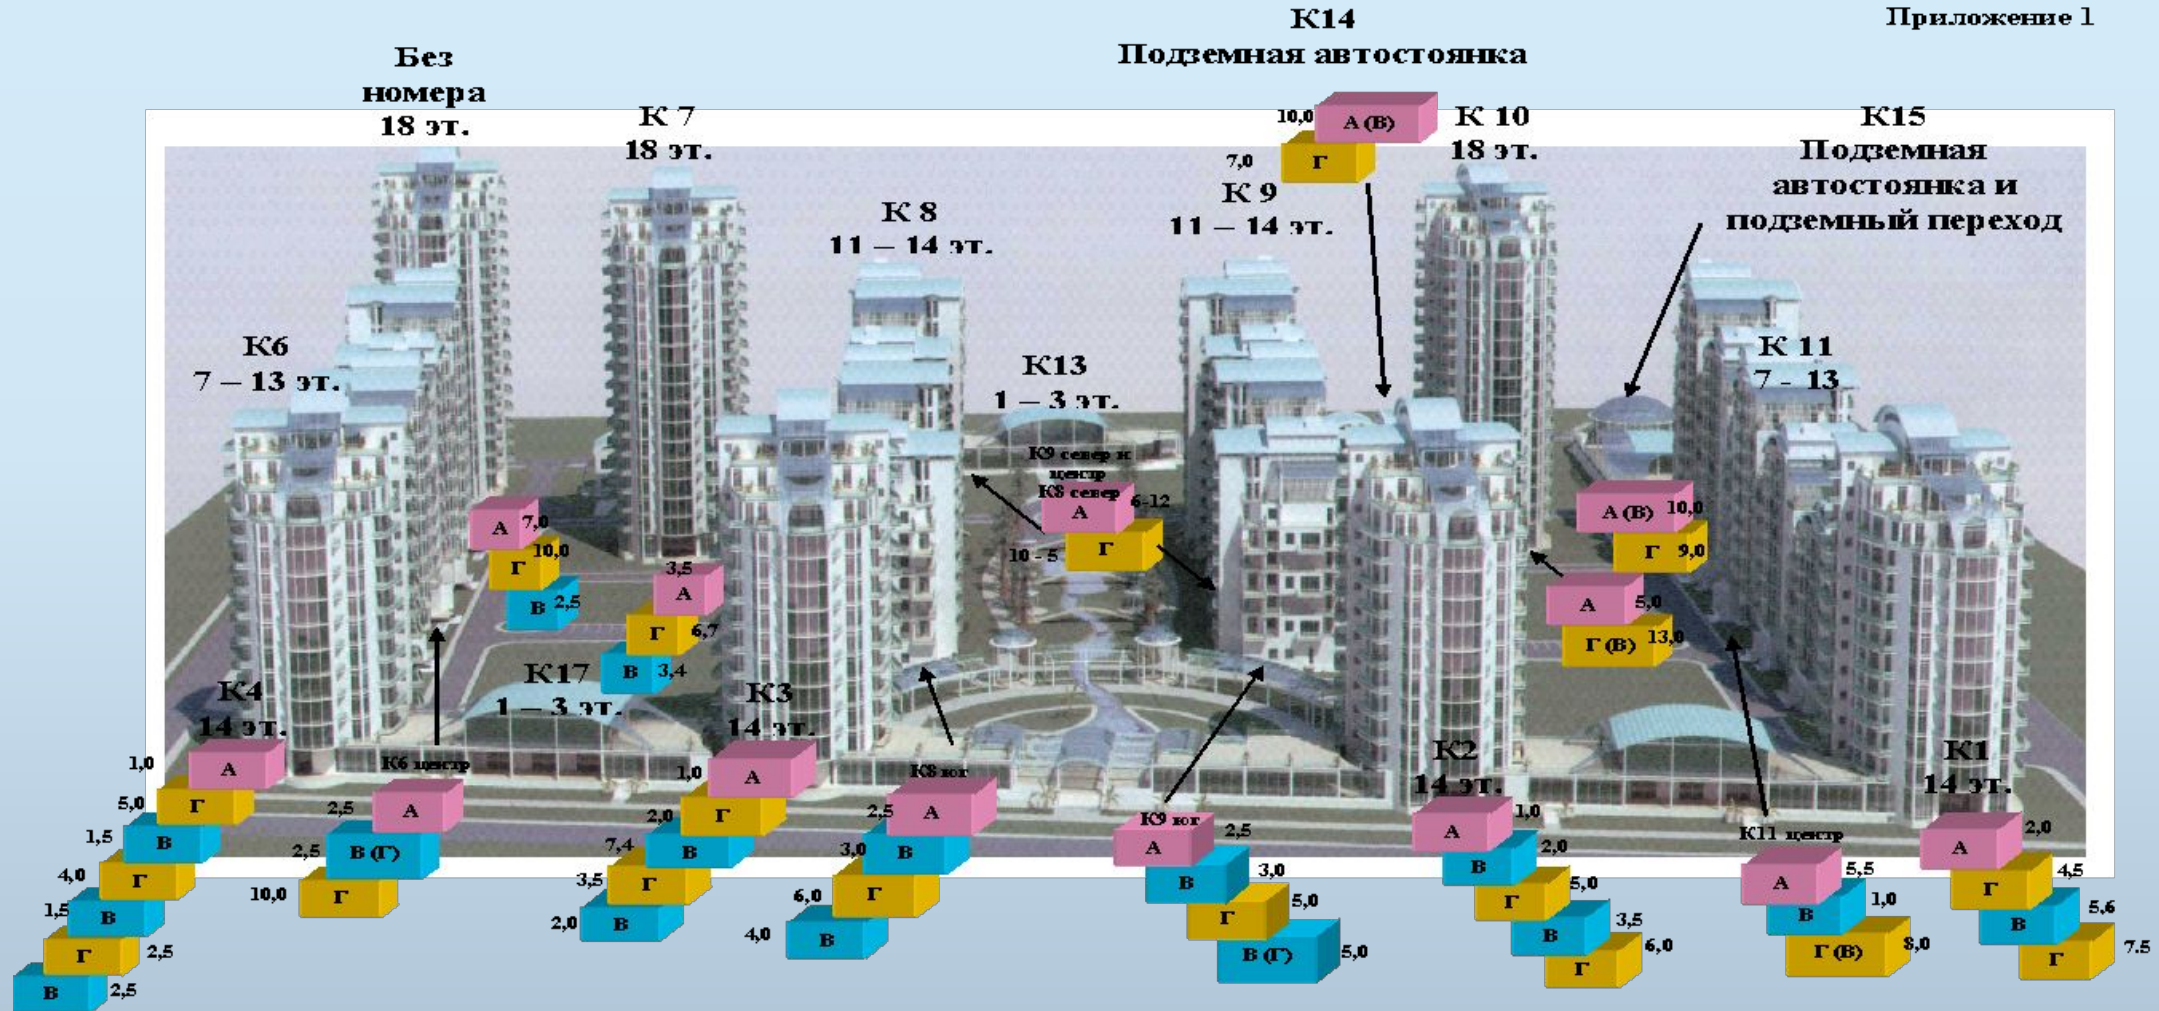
Схема технологии закрепления слабых грунтов и устройства свайных фундаментов многоэтажных зданий
